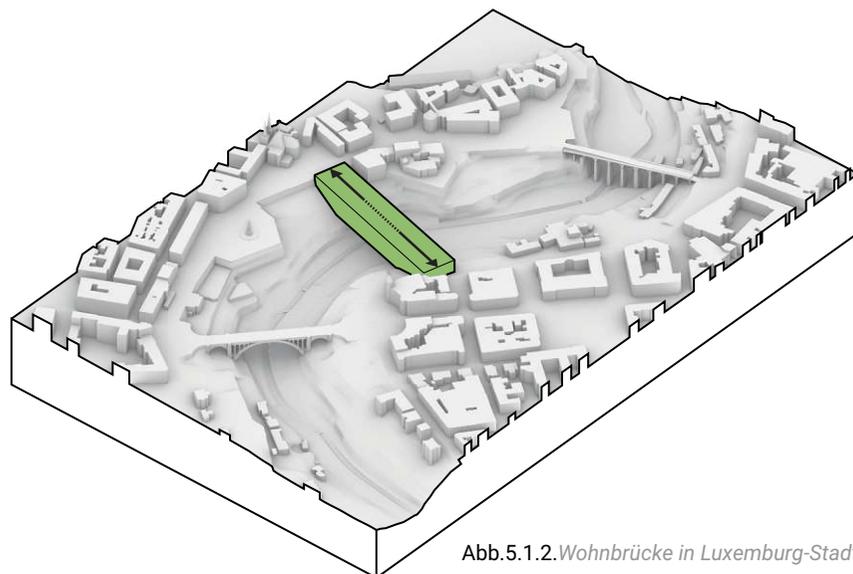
Wohnbrücke in Luxemburg-Stadt
